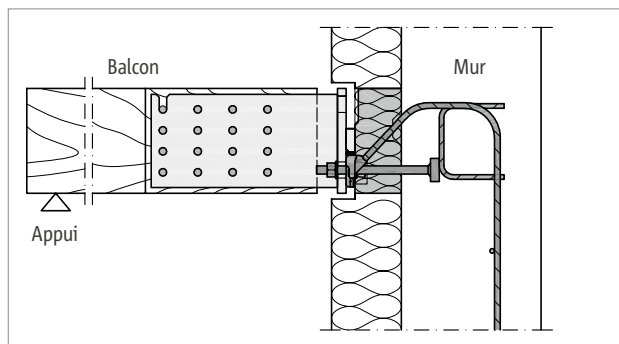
Schöck Isokorb® T type SQ-WU avec gabarit en acier : construction spéciale ; nécessaire en cas de raccordement à un mur en béton armé d'une épaisseur d'au moins 200 mm
